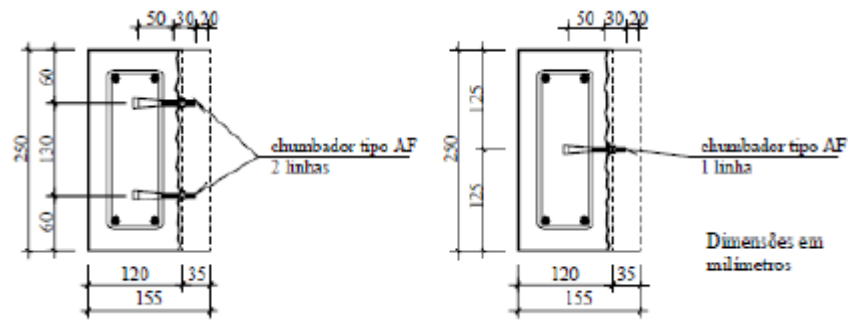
Detalhe da posição da instalação dos chumbadores (SAHB, 2008)
